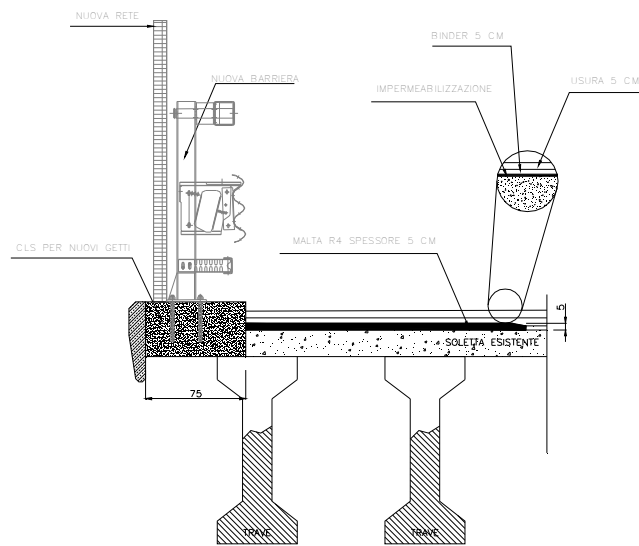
Sezione impalcato esistente con evidenza dell'intervento di demolizione.
